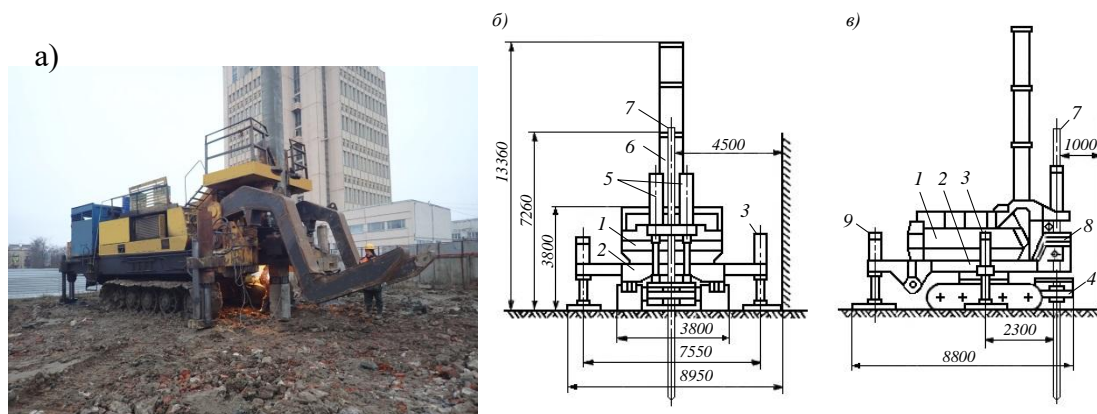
Сваевдавливающая установка УСВ-120 (160): а – общий вид; б – вид спереди; в – вид сбоку; 1 – ходовая тележка экскаватора ЭО-6122; 2 – рама; 3 – аутригер боковой; 4 – механизм зажима; 5 – гидравлический цилиндр вдавливания свай; 6 – мачта; 7 – свая; 8 – пригруз; 9 – аутригер задний
